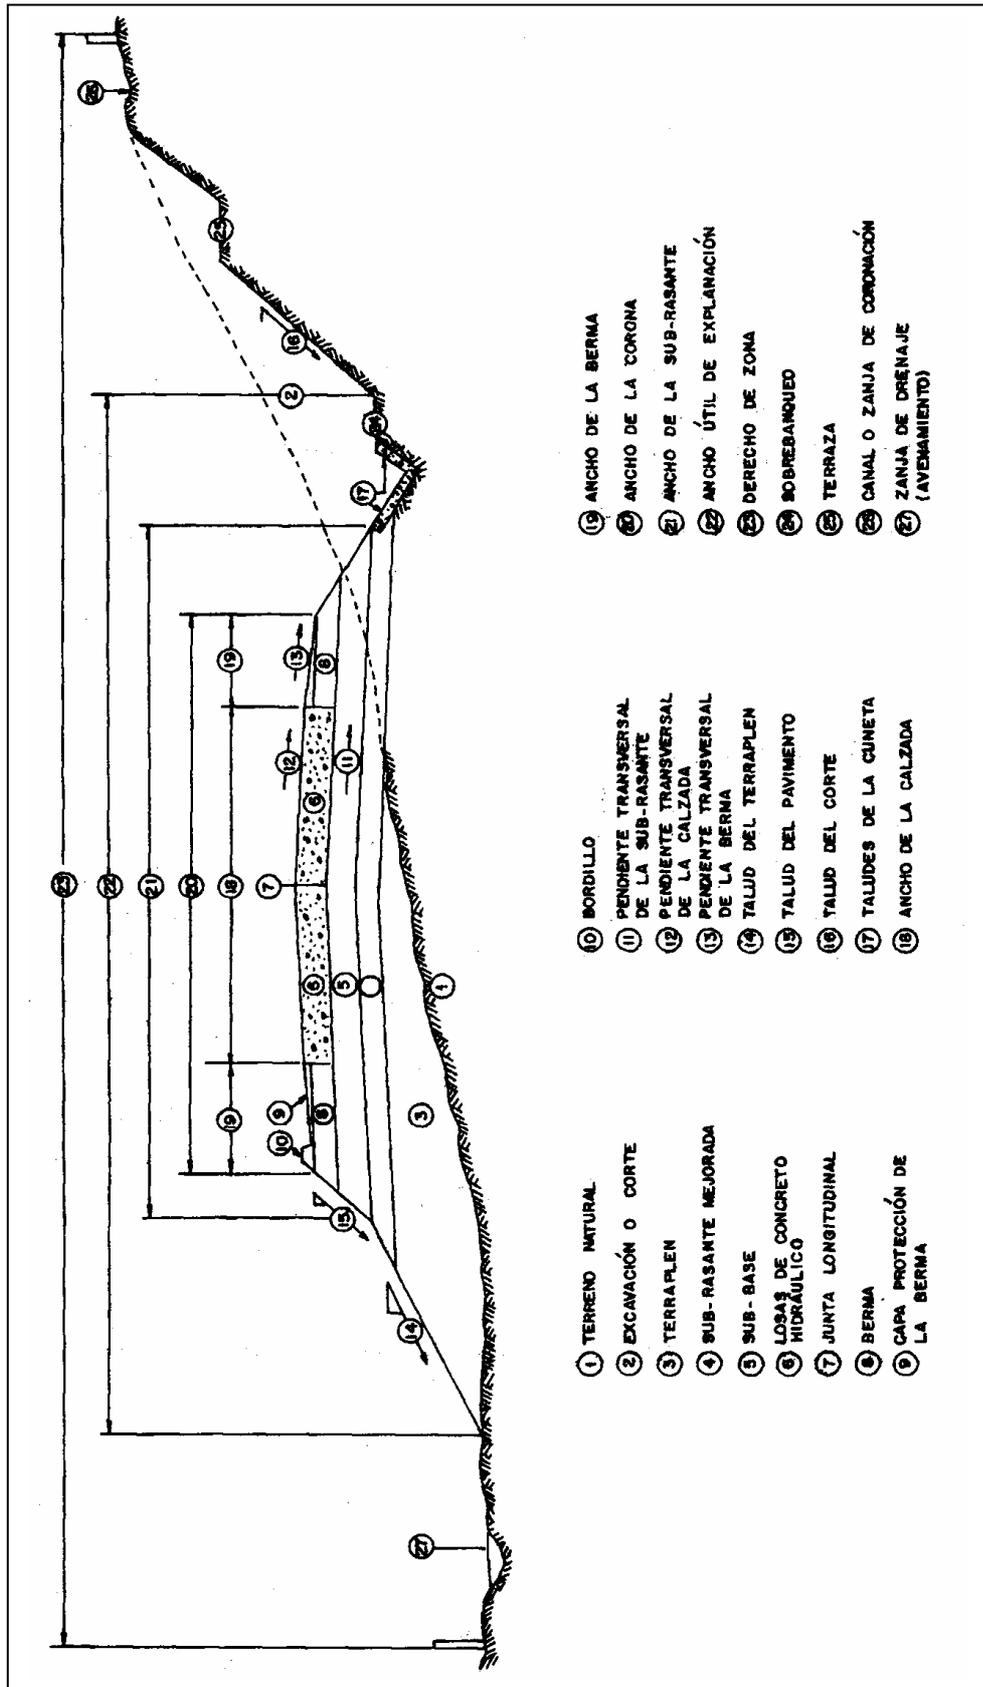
Sección Típica de un Pavimento Rígido
